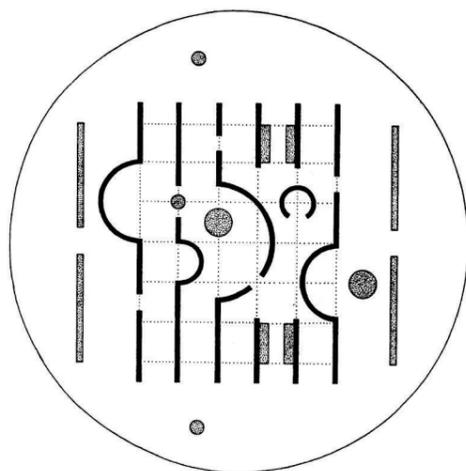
Planta del Pabellón Sonsbeek, 1966.
